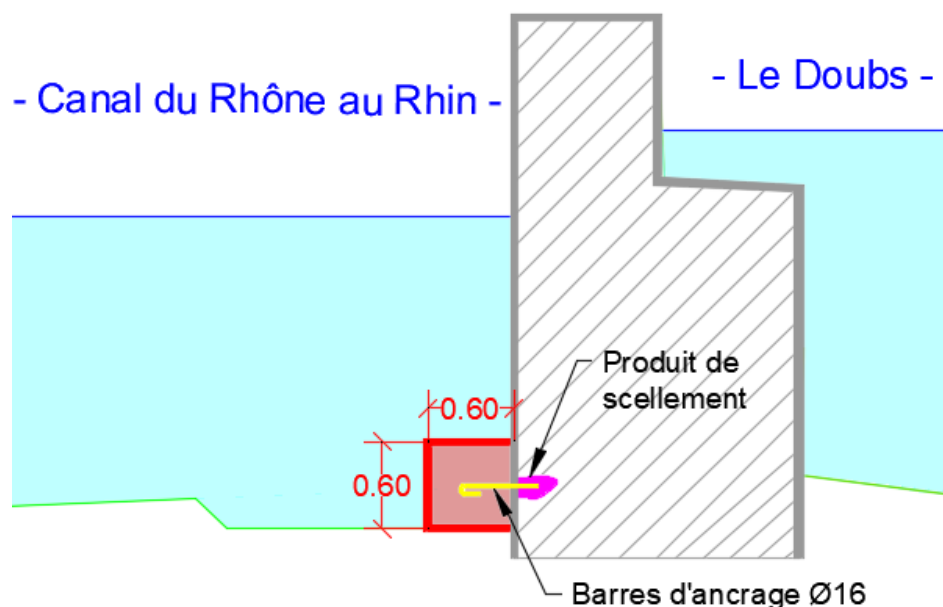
Coupe type de l'ancrage de la longrine en pied du mur
